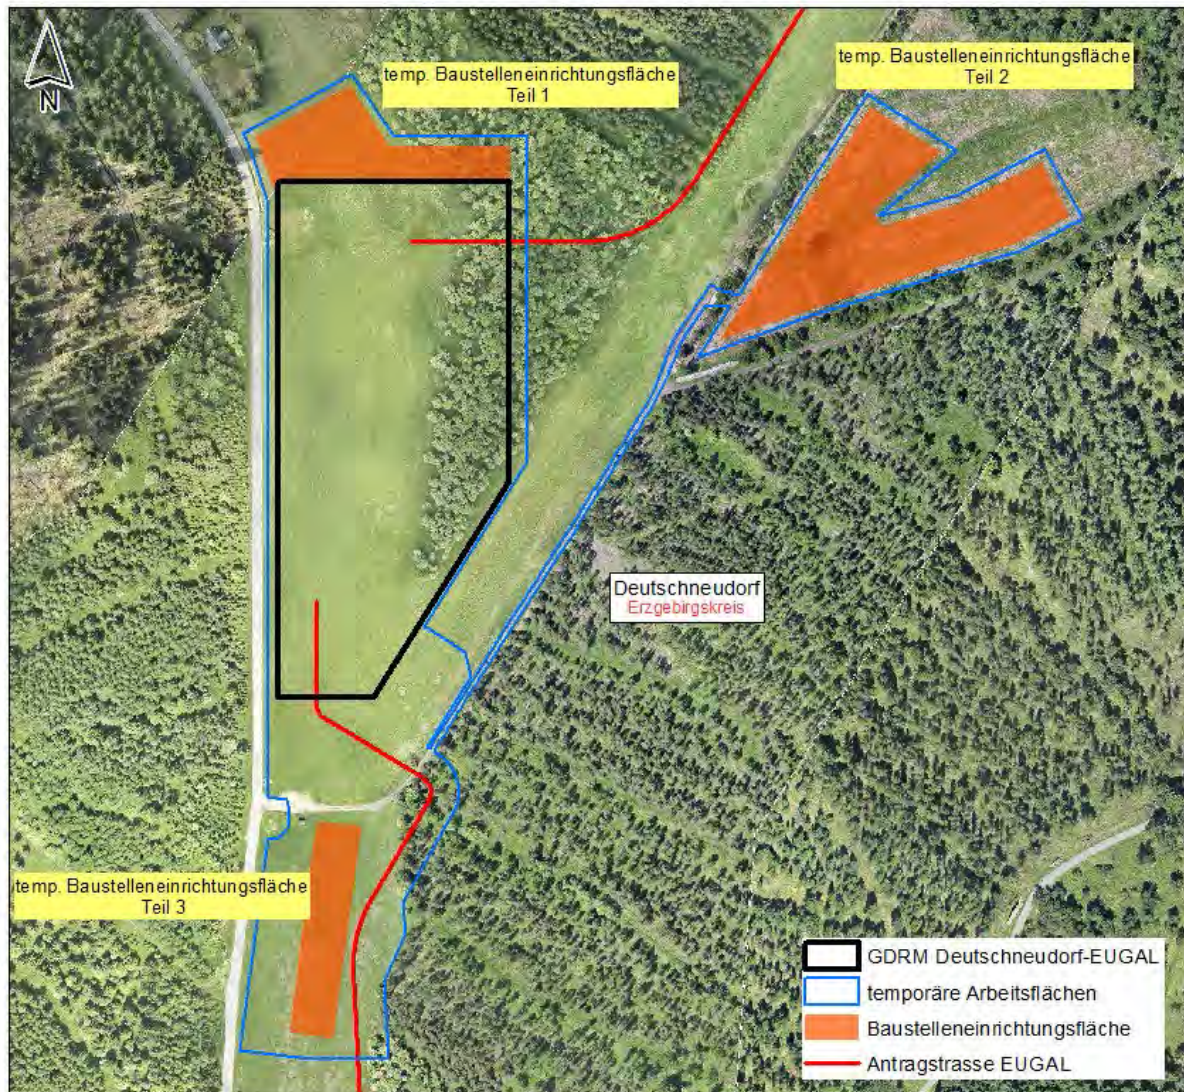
Temporäre Baustelleneinrichtungsflächen für den Bau der GDRM-Anlage
